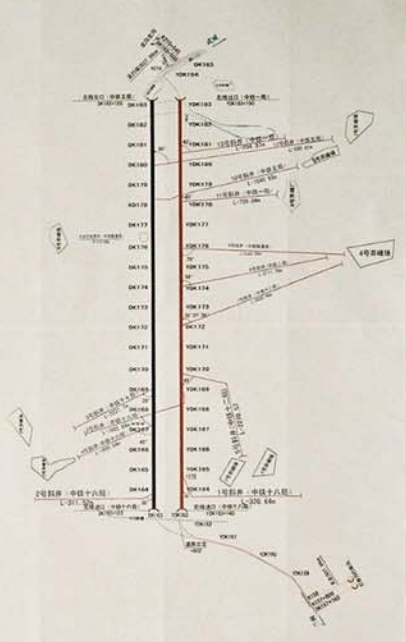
Übersichtsplan des Tunnels, Kurze Projektentführung. Der Wushaojing-Tunnel verläuft zwischen den Bahnhöfen Dachigou und Longgou und besteht aus zwei Einzeltunneln von je 20.050 Metern Länge. Der Abstand zwischen den beiden Tunneln beträgt 40 Meter, bei einem Gefälle von 1,1%. Die Tunnelneigung liegt 2663 m über N.N., die Tunnelausfahrt 2447 m über N.N. Der Tunnel verläuft maximal 1100 m tief unter der Erde und führt durch vier geologische Verwerfungsstellen. Der linke Tunnel entsteht im Parallelvortrieb zum rechten Tunnel, zusätzlich werden 13 Zugangstunnel und ein Schacht gebaut. Die Bauarbeiten am rechten Tunnel sollen bis zum 21.10.2005 abgeschlossen sein.
